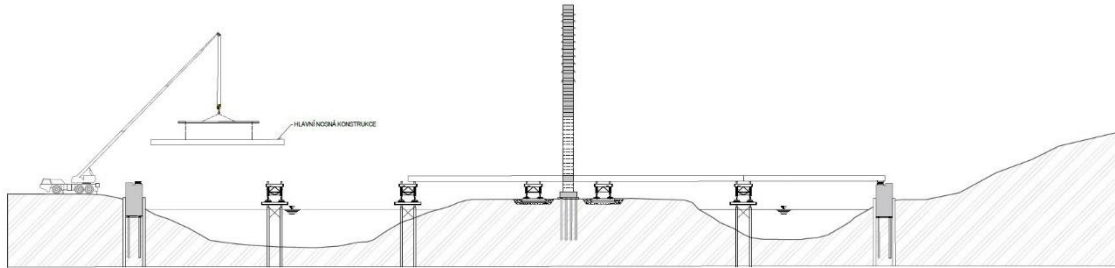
Fáze 2- betonáž krajních opěr a základu středového pylonu
